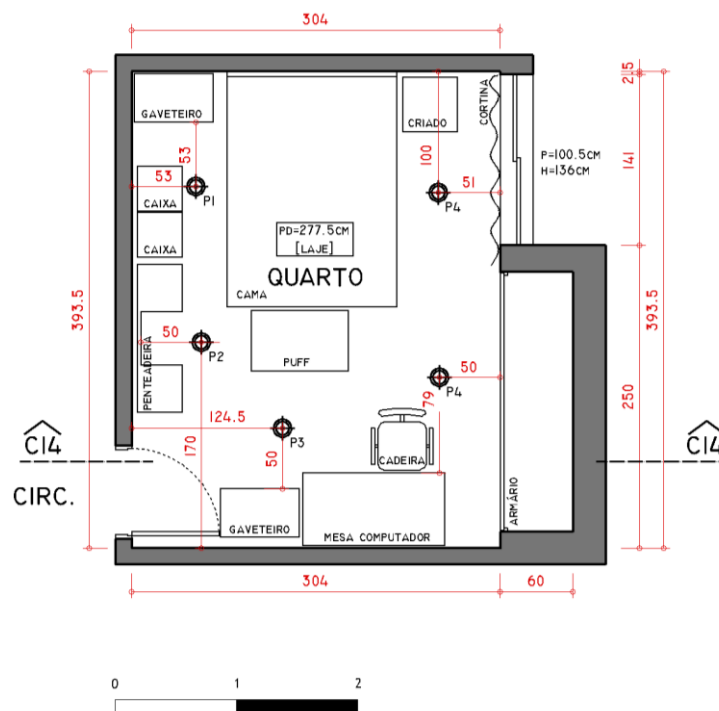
Planta ambiente receptor (pavto. inferior) - Ensaio 14
